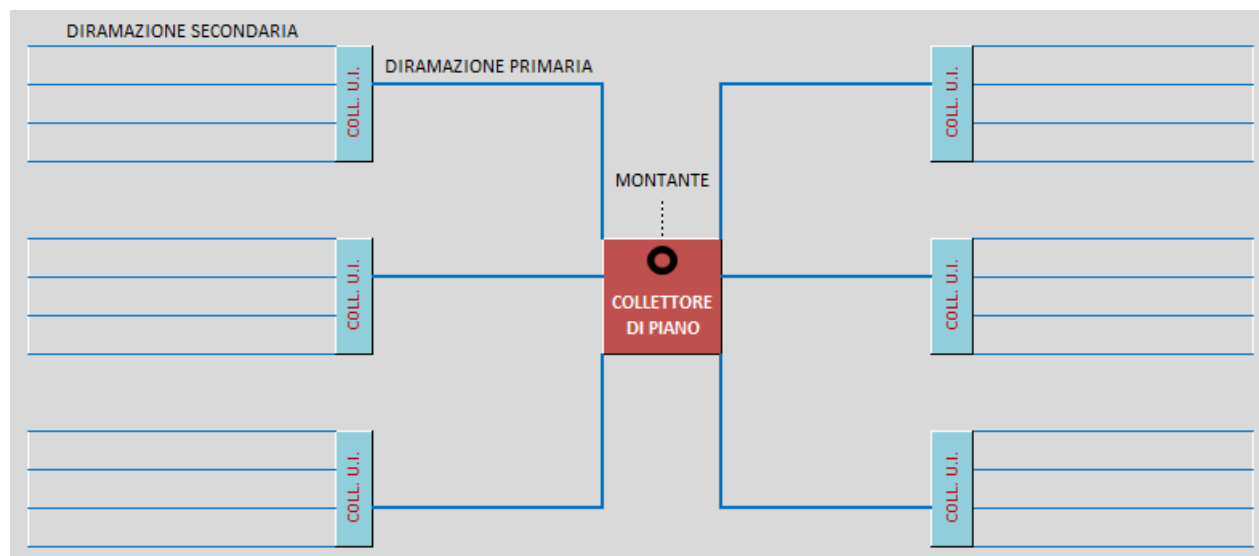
SCHEMA DELL'IMPIANTO AL PIANO
